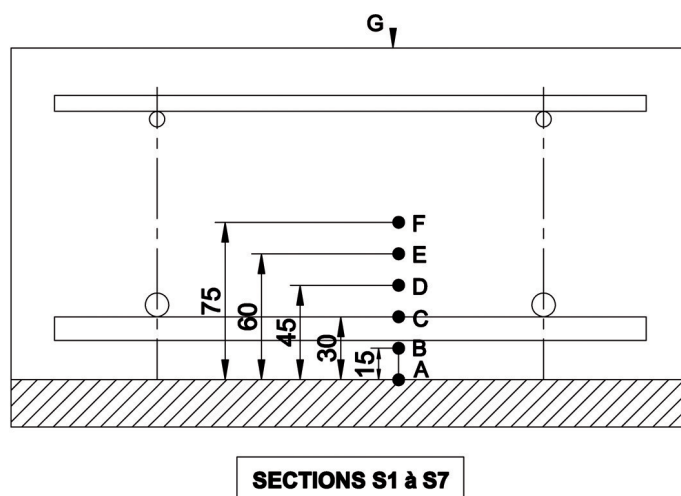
Positions des thermocouples dans la dalle béton (vue en coupe)
